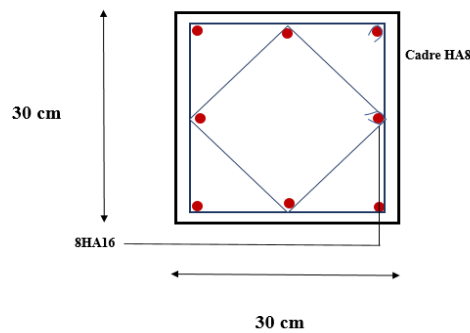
Schéma des Ferraillages des poteaux 30×30.
